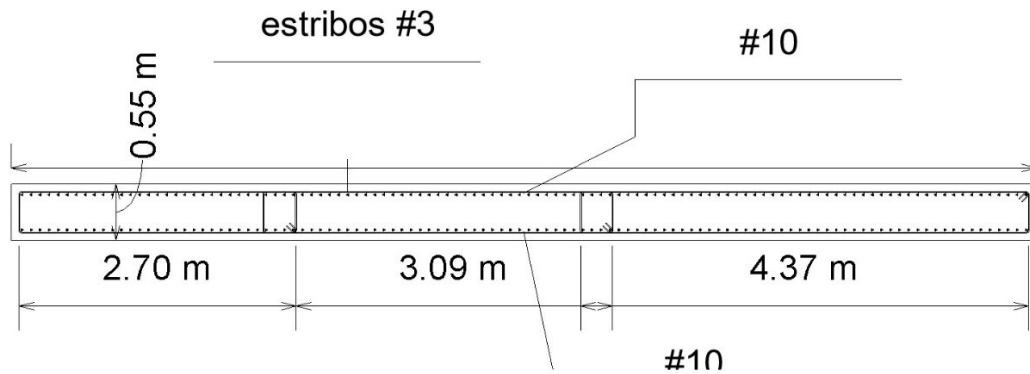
Detalle del refuerzo longitudinal de la losa de la alcantarilla de una celda.
